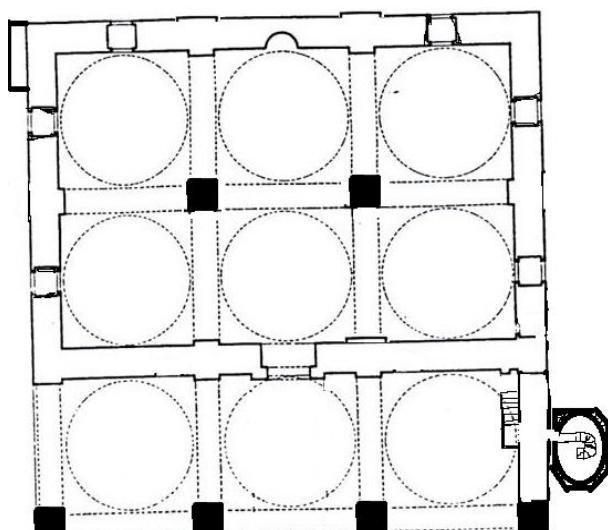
مسقط اافقى لجامع سنان باشا بالقاهرة.
